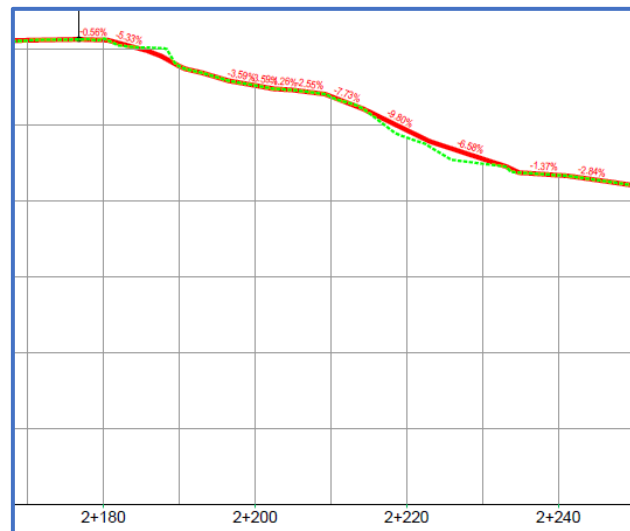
Detalle del perfil longitudinal del carril bici entre el aparcamiento cementerio y la NA-6053.
